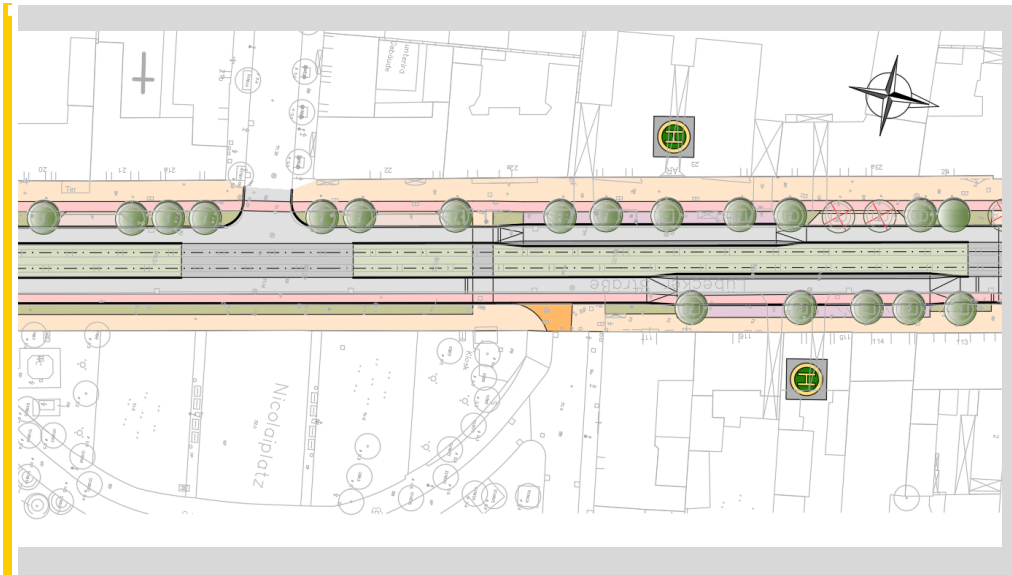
Lübecker Straße Mitte, Lageplanausschnitt V1
